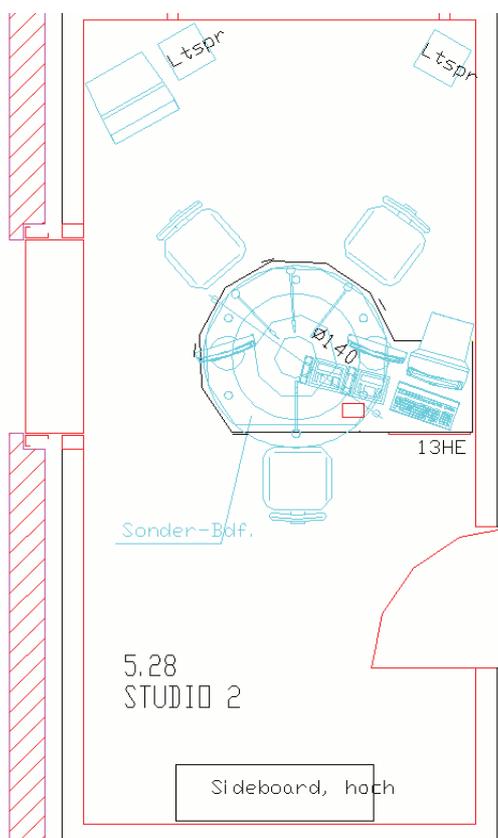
Grundriss Studio 2 mit alten Möbeln
